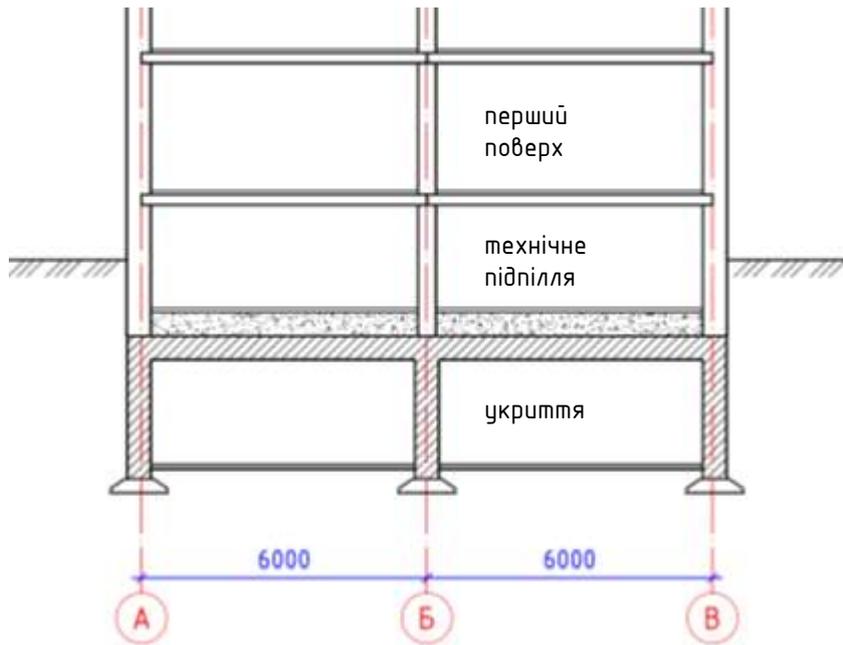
Поперечний розріз укриття, розташованого під технічним підпіллям у житловому будинку
